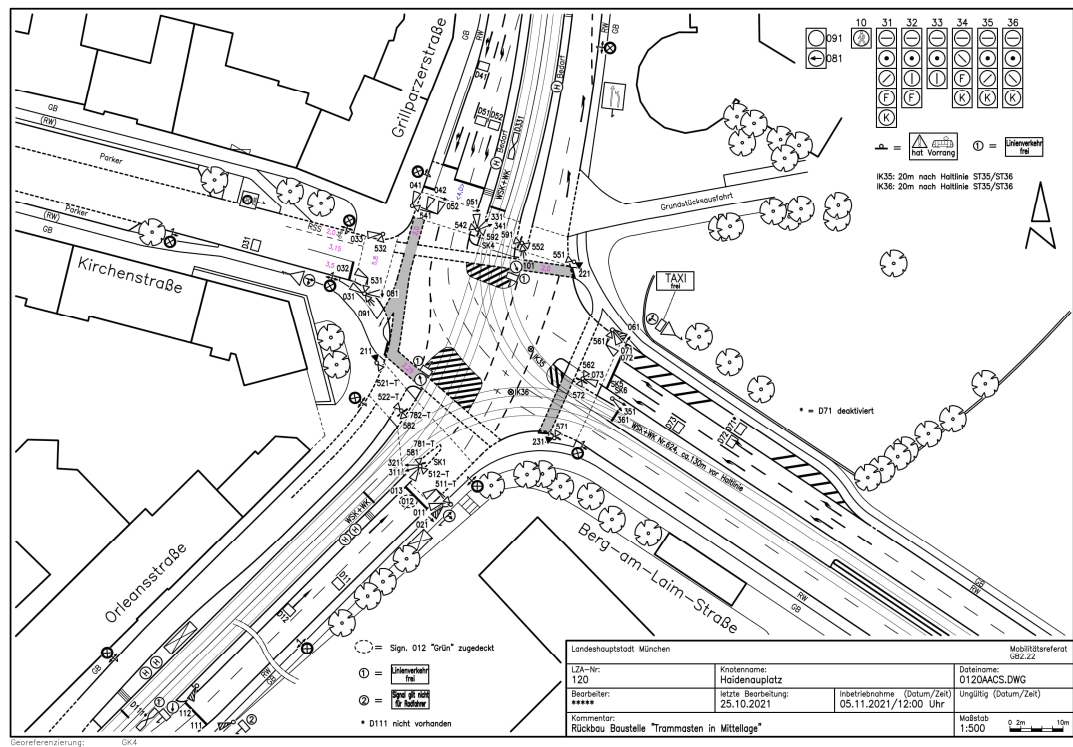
Signallageplan Knotenpunkt Grillparzerstraße / Berg-am-Laim-Straße (LZA-Nr. 120), [Quelle: LHM]
